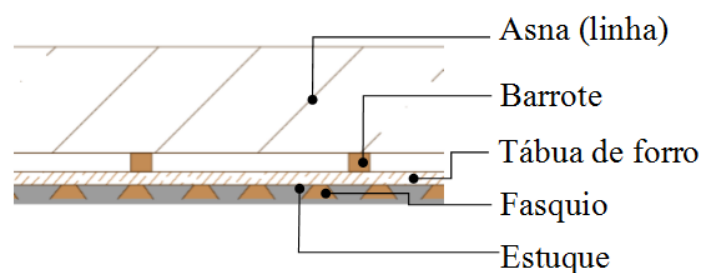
Esquema da laje de esteira (corte transversal)
